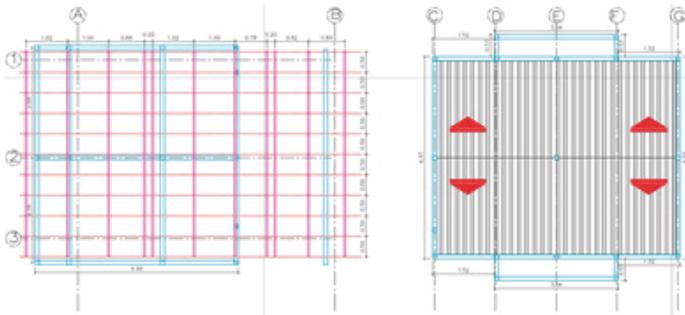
Planta estructural guías de tejas vivienda modular sostenible
